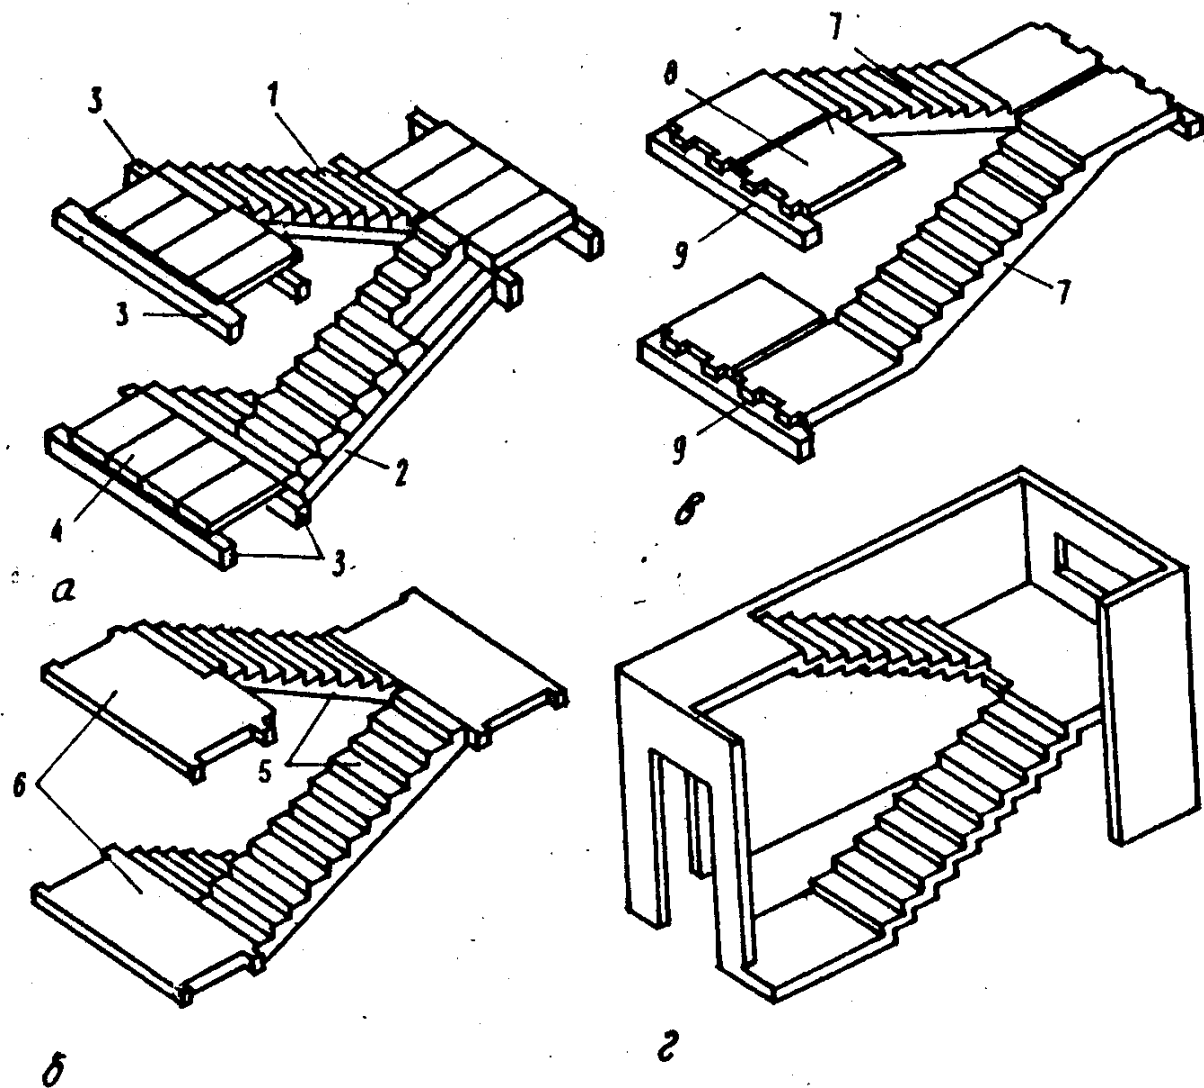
Схеми збірних залізобетонних сходів:
